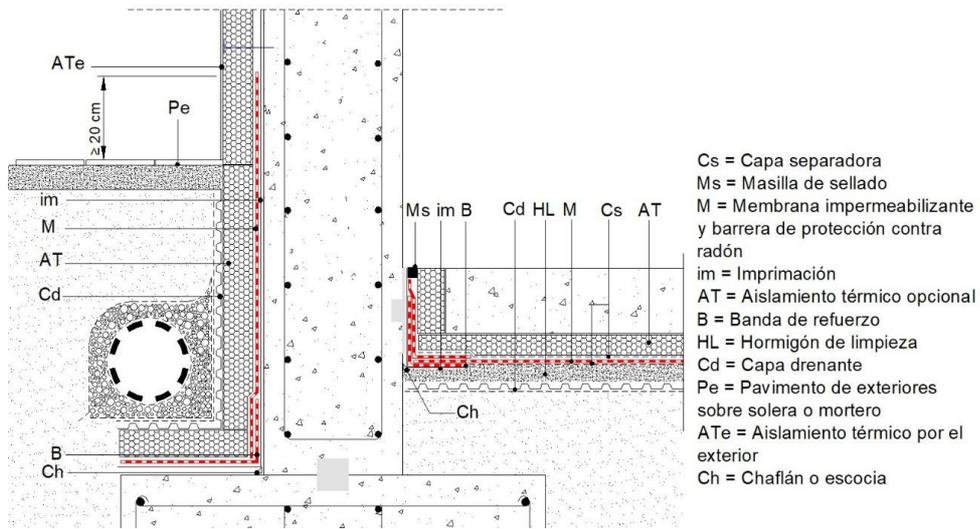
Placa y muro con barrera de protección contra el radón e impermeabilización por el exterior. Sistema bicapa no adherido en placa y sistema monocapa adherido en muro
